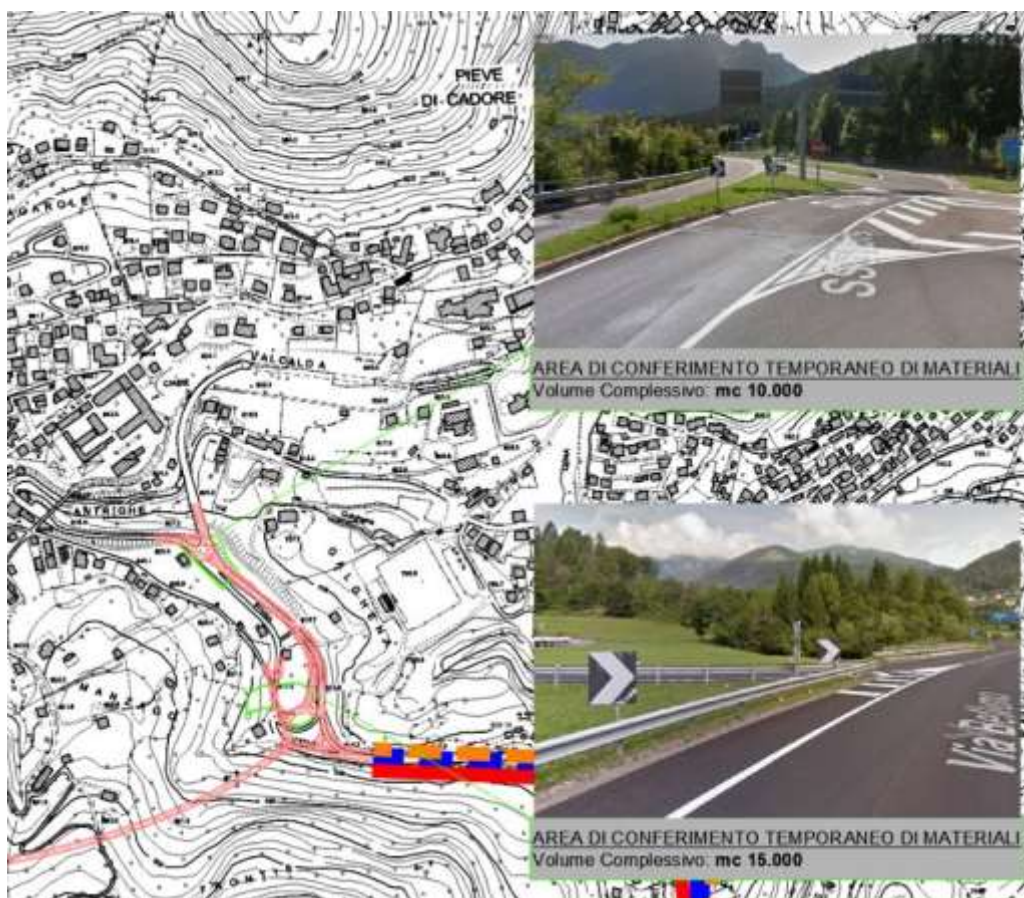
Planimetrie di cantiere, siti di deposito temporaneo e viabilità - Deposito Temporaneo T2 – T3
